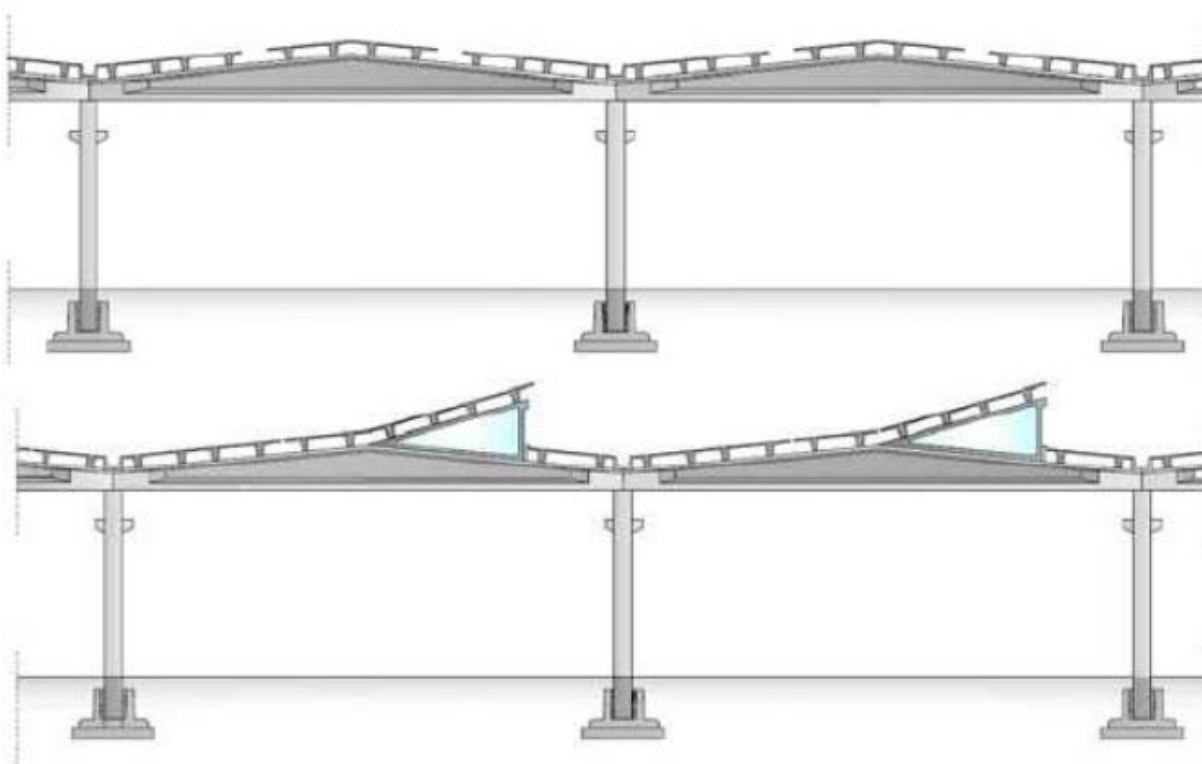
Esempi di copertura a doppia pendenza con tegoli nervati
